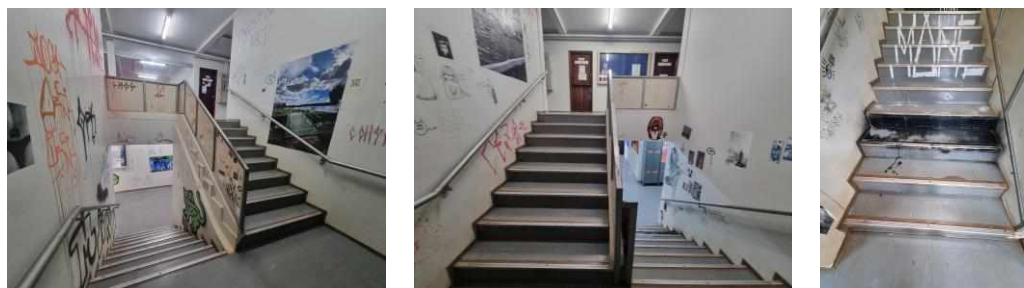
Vistas do acesso principal e circulações do pavimento térreo e primeiro pavimento, respectivamente.
